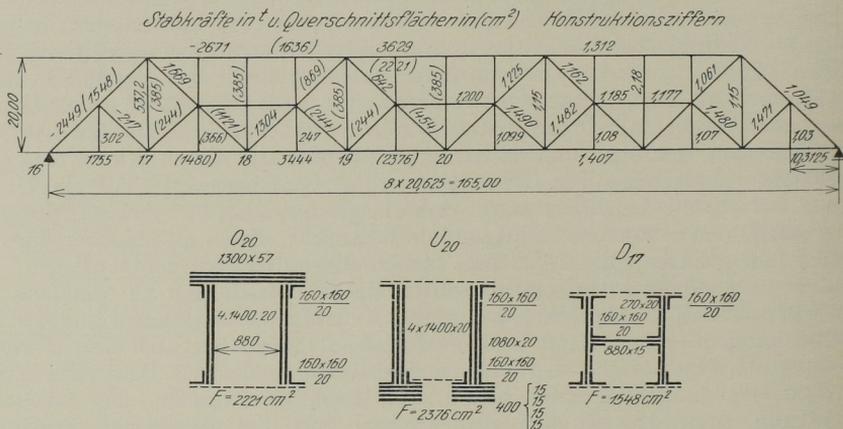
Konstruktionsbeiwerte eines Parallelträgers bei Ausführung in St-Steel
